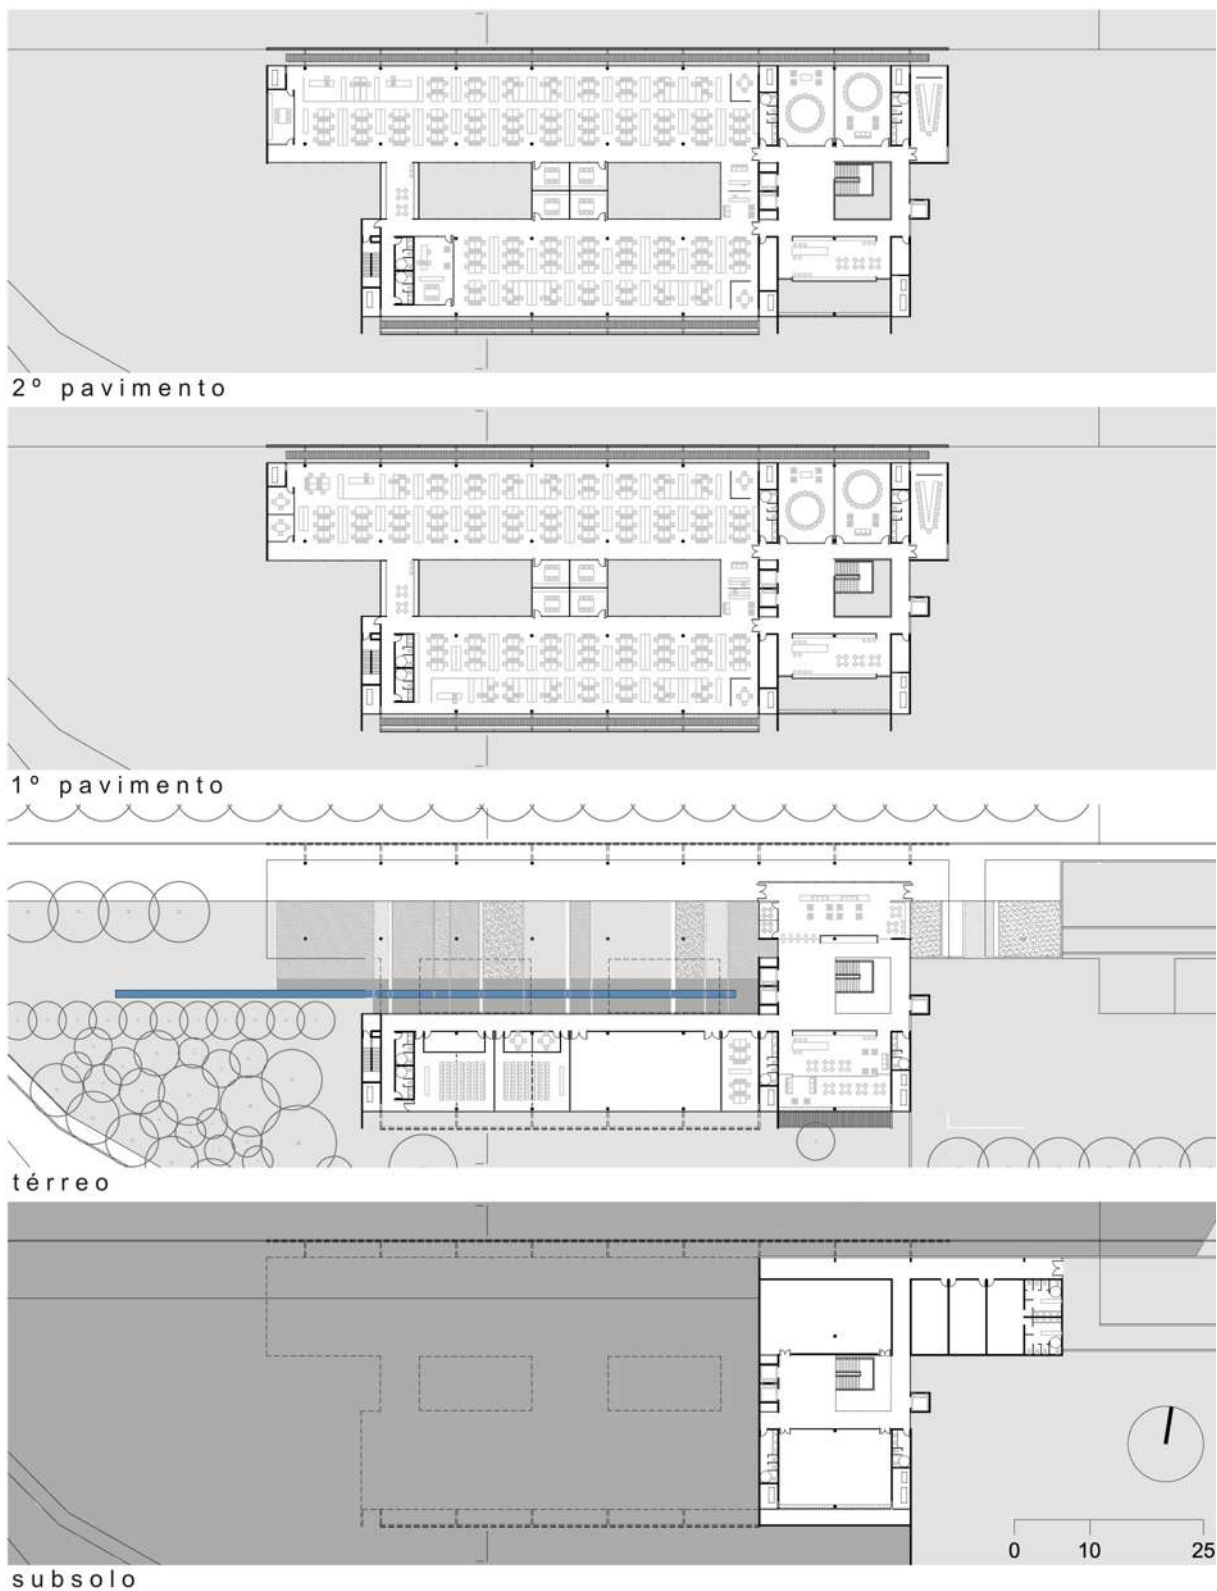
SAP Labs Brazil, plantas dos pavimentos, Conceituação do Projeto, escala 1/1000 (imagem gentilmente cedida pela Eduardo de Almeida Arquitetos Associados e Estúdio 6 Arquitetos)
